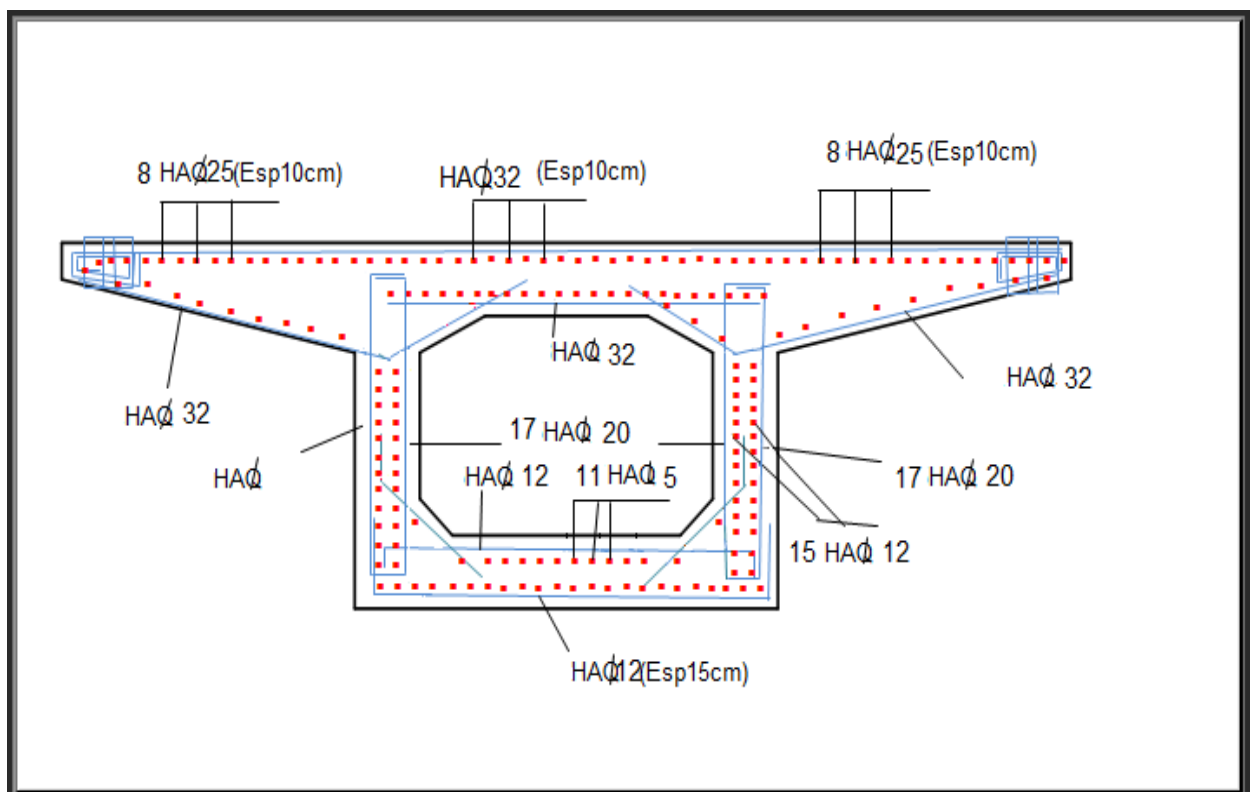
Schéma du Ferrailage du voussoir près de la clé.
